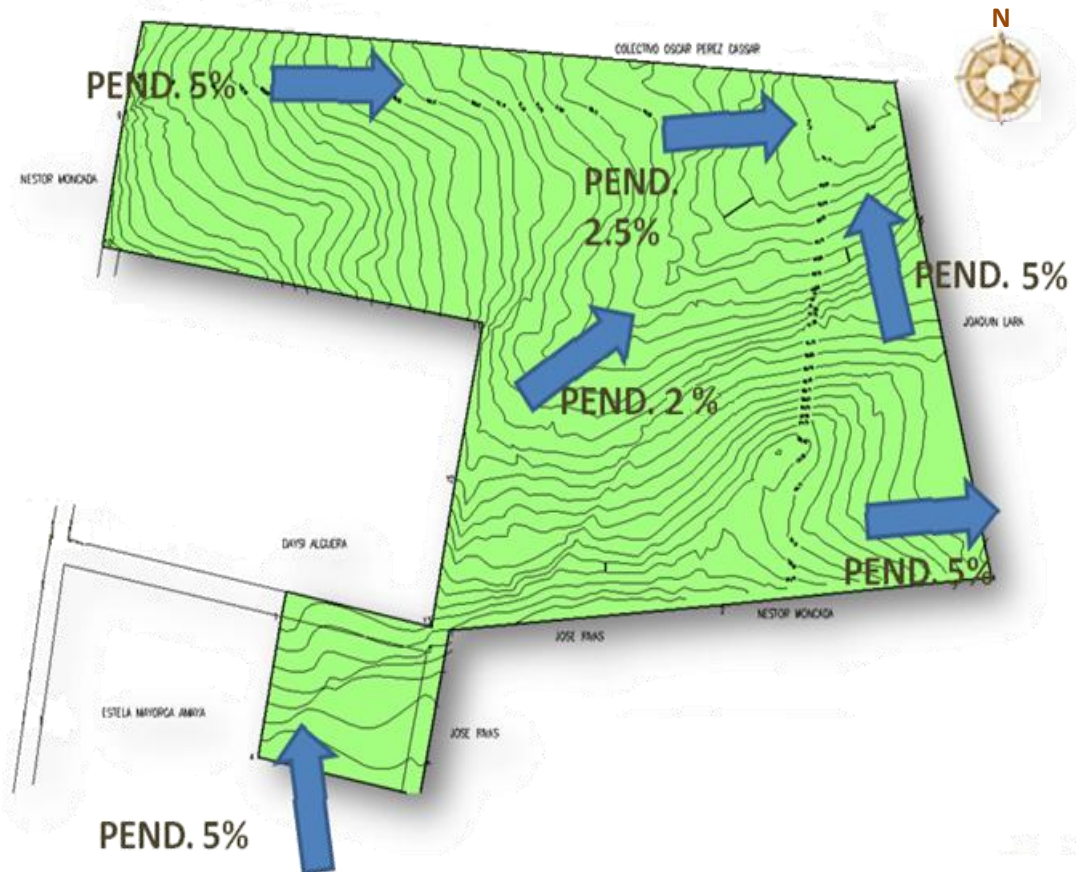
Pendientes encontradas en el sitio del proyecto.
